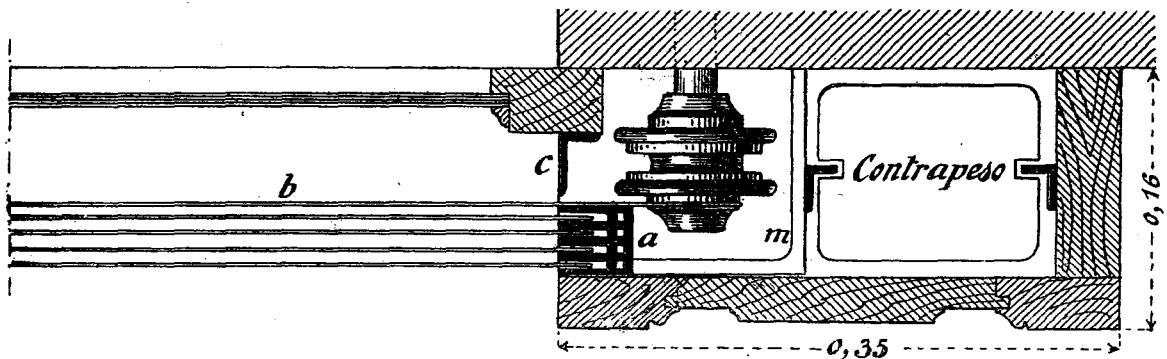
Cierre sistema Chédeville: detalle de la caja.
